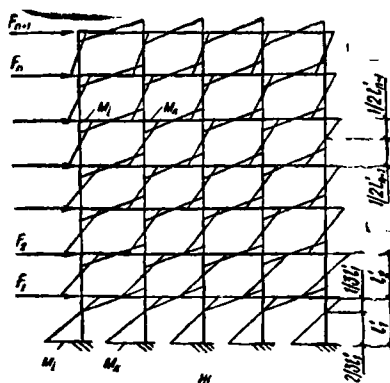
Розрахункові схеми багатоповерхових каркасних будівель:
